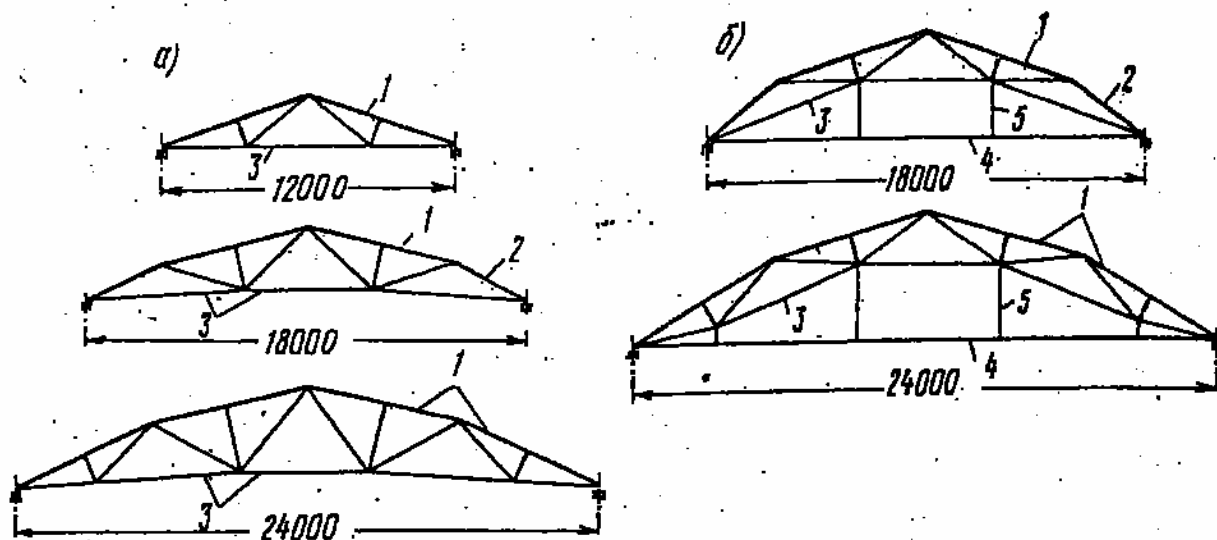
Схемы металлодеревянных ферм: а – балочные; б – арочные; 1 – шпренгельная балка; 2 – опорный брус; 3 – тяг нижнего пояса; 4 – затяжка; 5 – подвеска.
